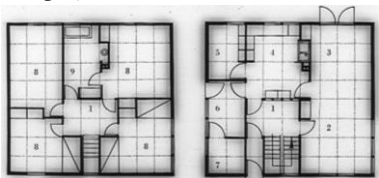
Planta da casa experimental n.º.17 de Walter Gropius para a Weissenhof, Stuttgart, 1927
